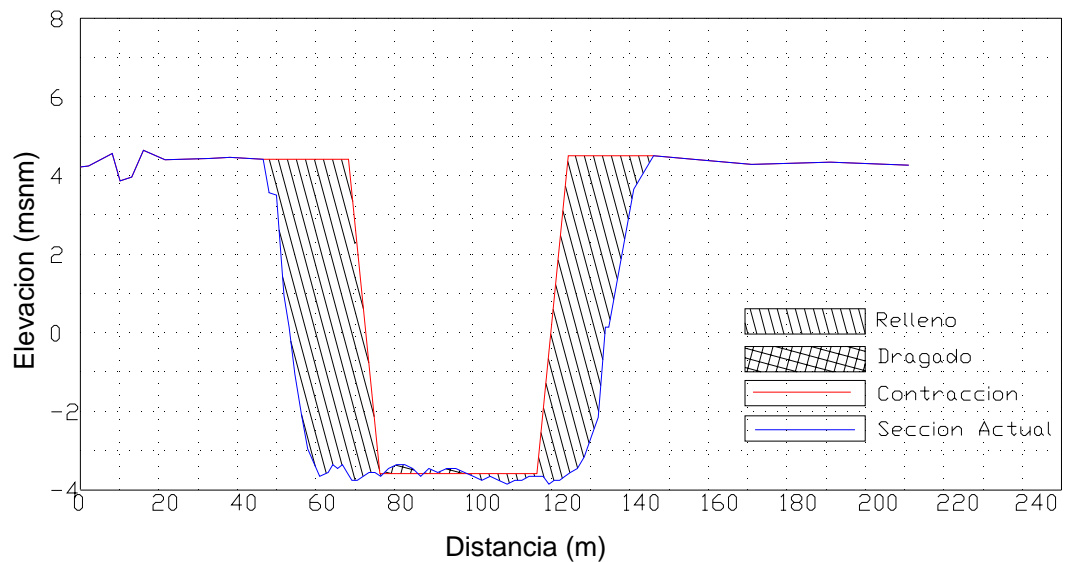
Sección transversal km 46 - Contracción No. 2
